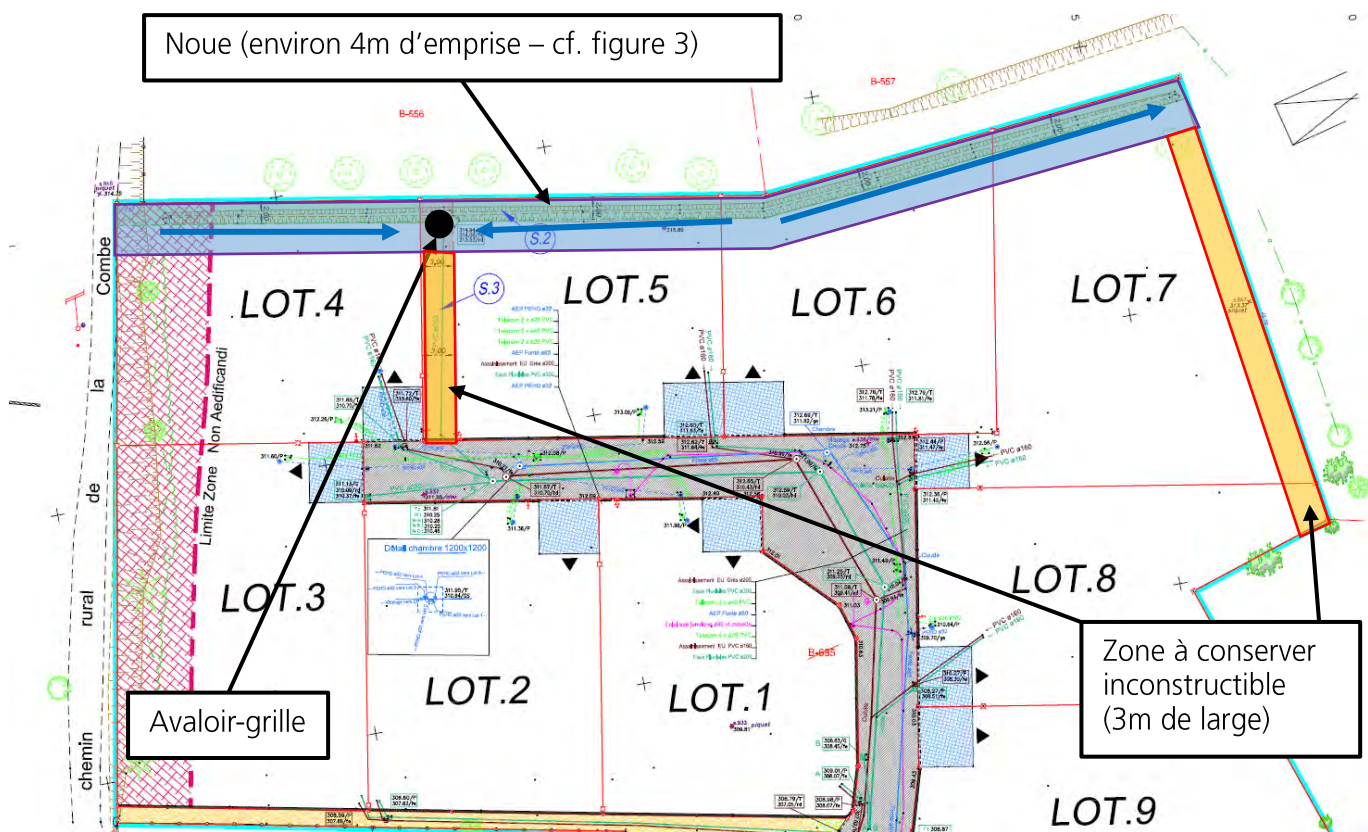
localisation de la noue et des zones à conserver non constructibles
